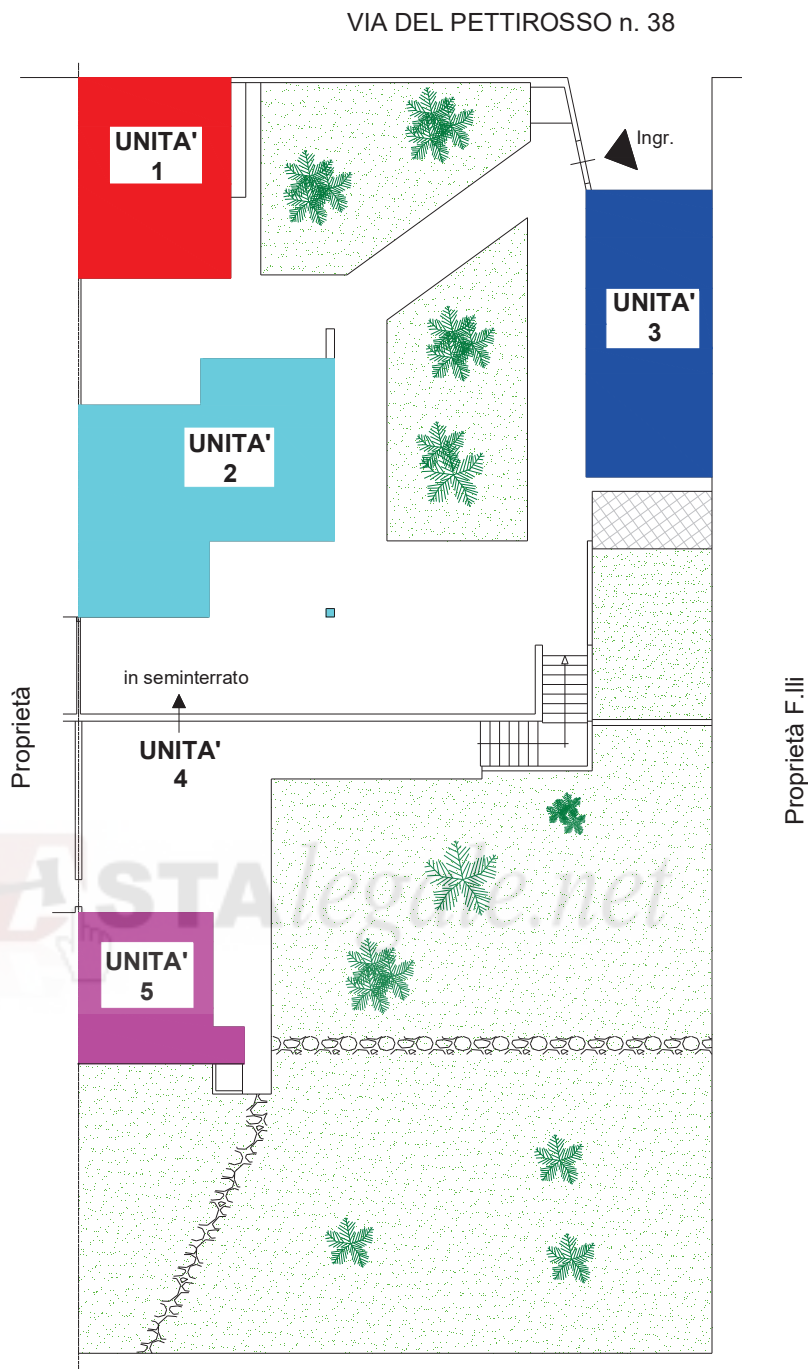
SCHEMA PLANIMETRICO DEI FABBRICATI
